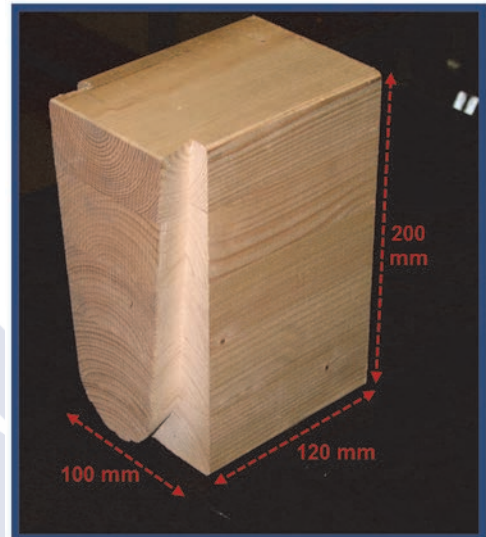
Probeta de madera laminada de píceas de sección de vigueta con espiga tallada en un extremo
